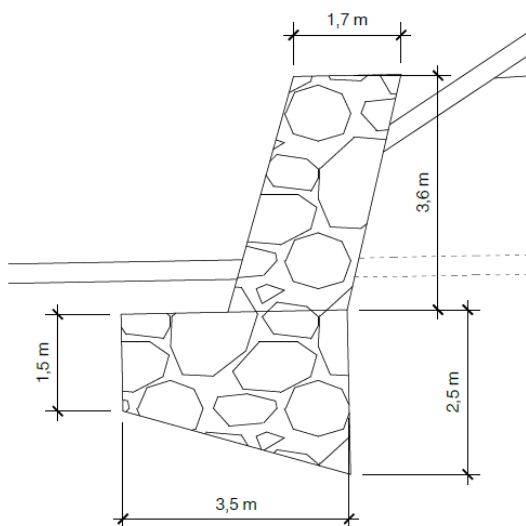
Detalles geométricos del muro de escollera introducido en el trazado de la vía proyectada.
